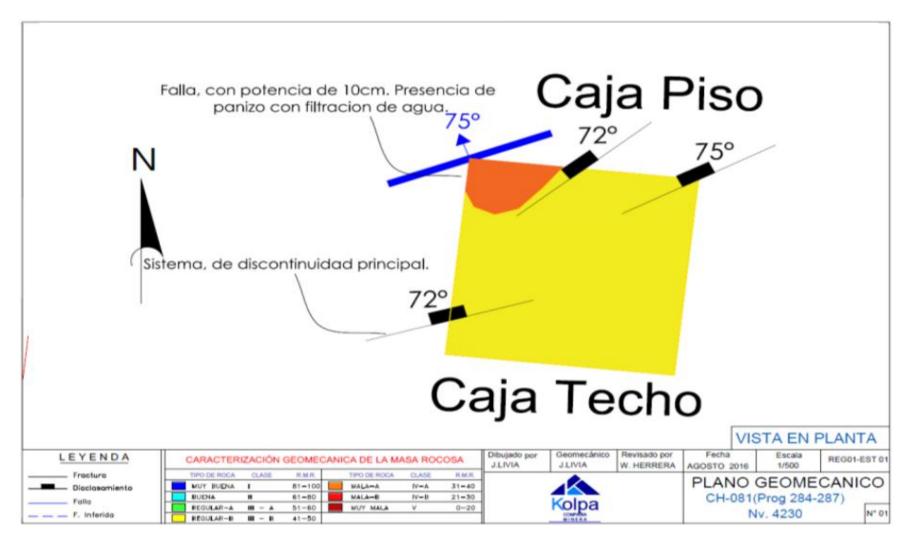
Plano Geomecánico CH - 081 (Vista en planta)
